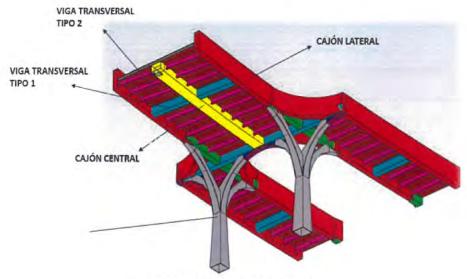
Estructura del puente. Fuente: Planos de proyecto, 2021.
